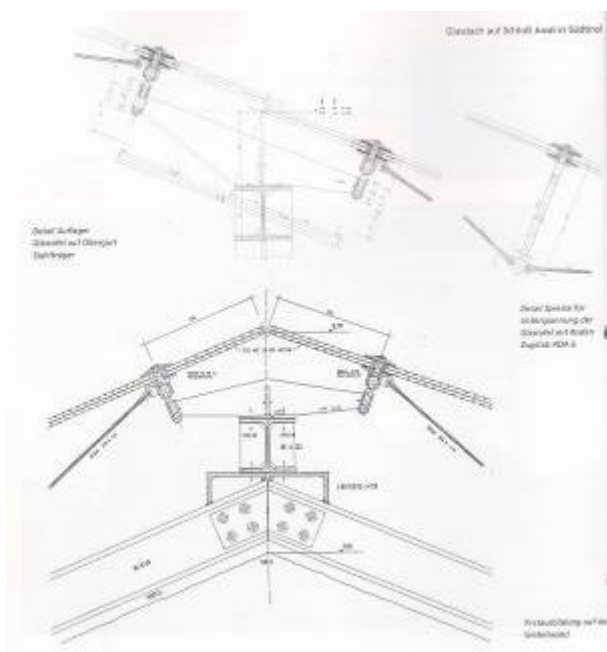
und 303: Grundriss des Glasdachs und Details des Zugstabsystems.
